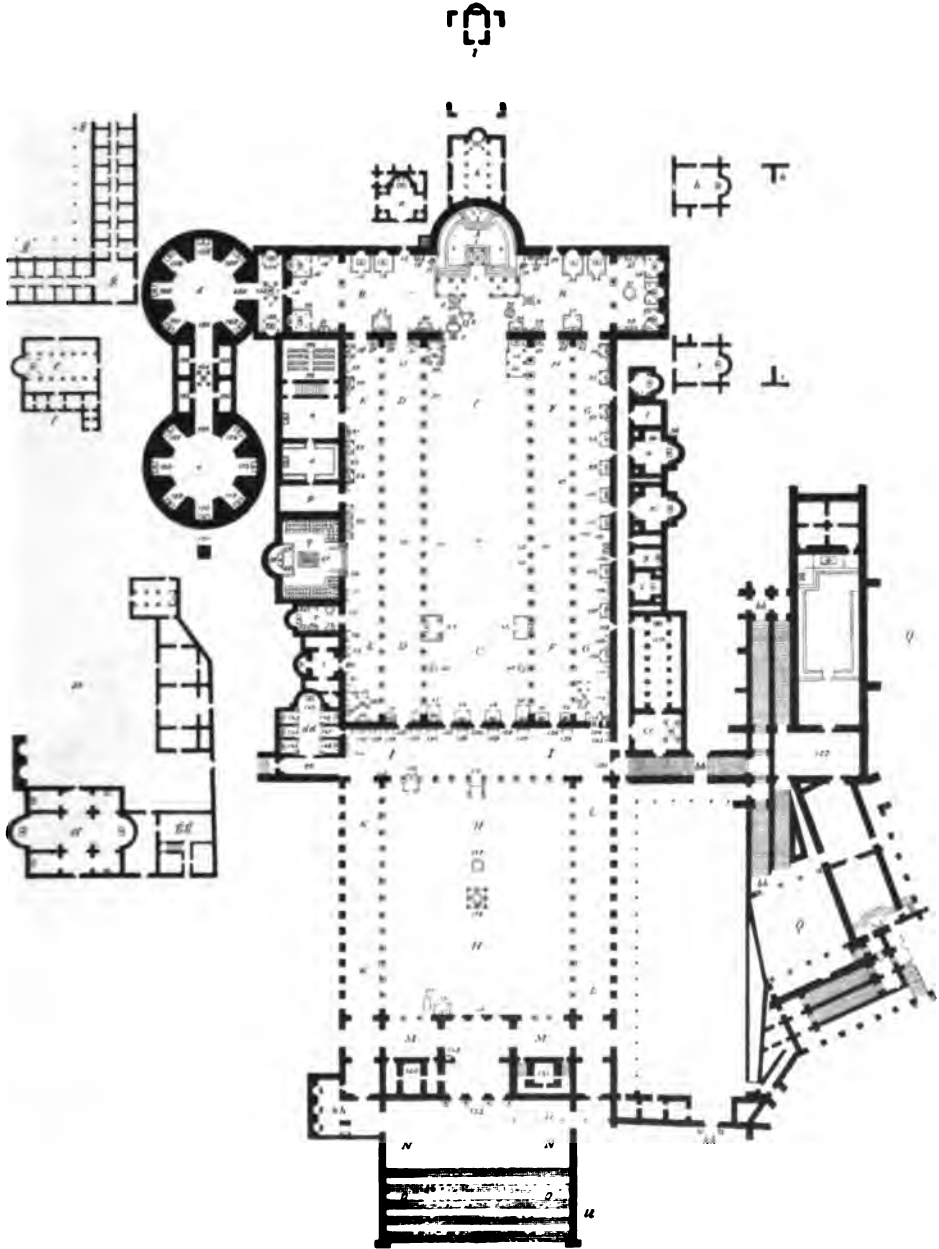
Grundriss der alten St. Peterskirche.
